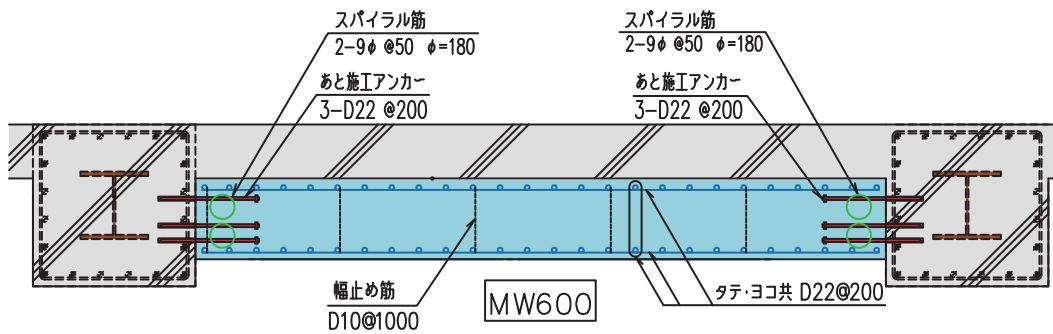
追設耐震壁配筋詳細 (B-B 断面図)
